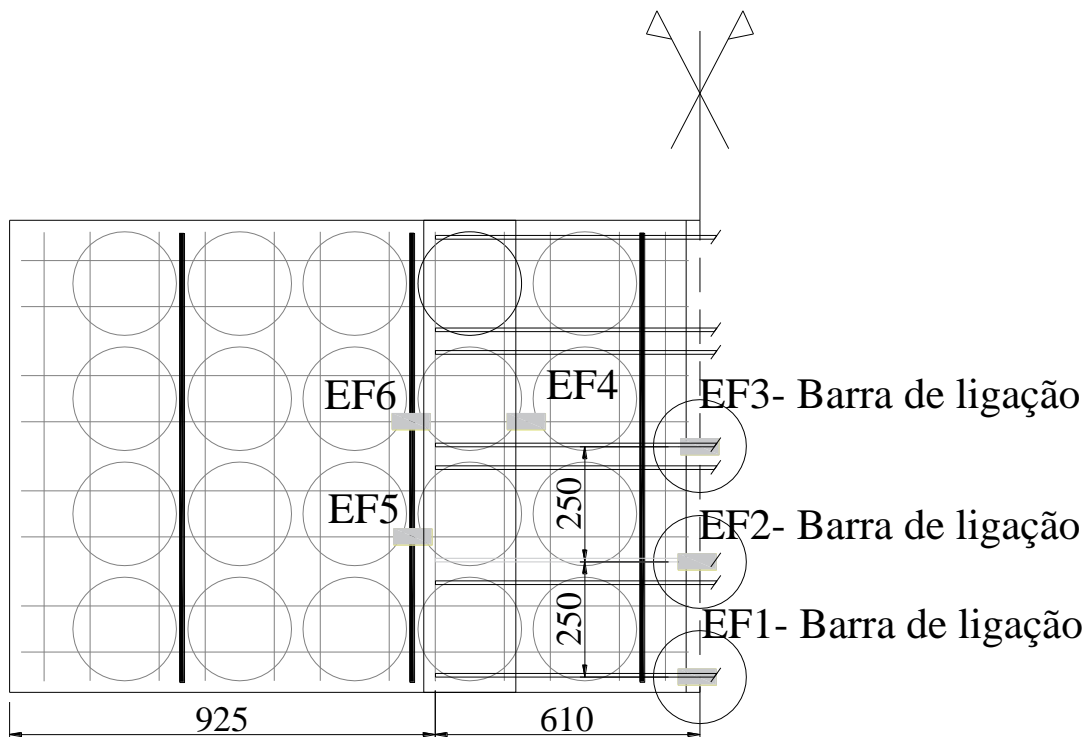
Extensômetros nas barras de aço da laje BD28-F3
